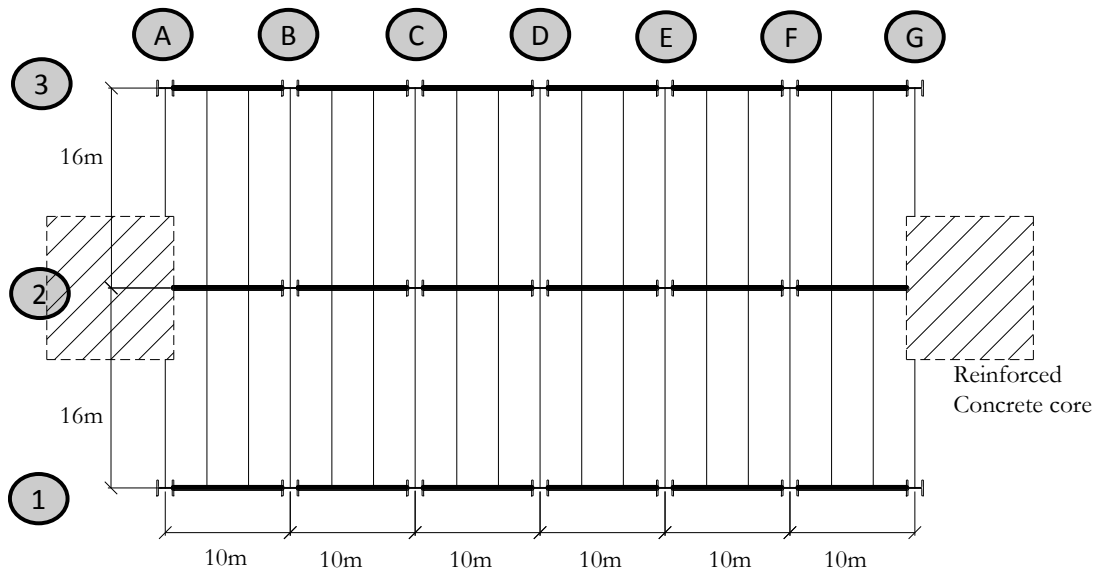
Grundriss der Referenzstruktur des Parkhauses
